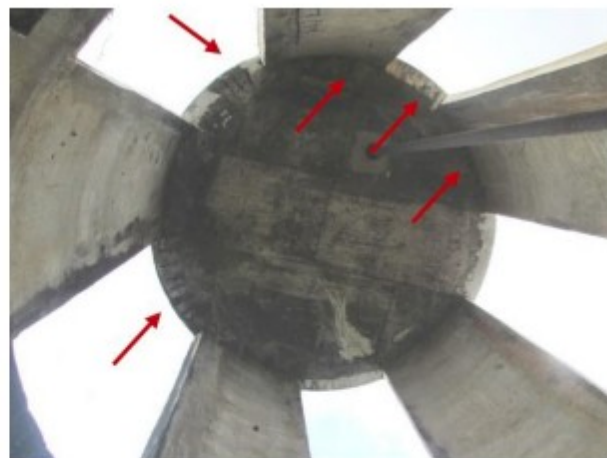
Vista externa da laje inferior da cuba com apontamento para diversos pontos de corrosão da armadura
